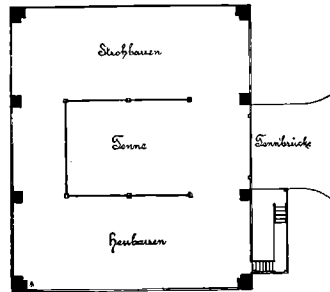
Grundriss des Obergeschosses des Sank-Stadel's.
